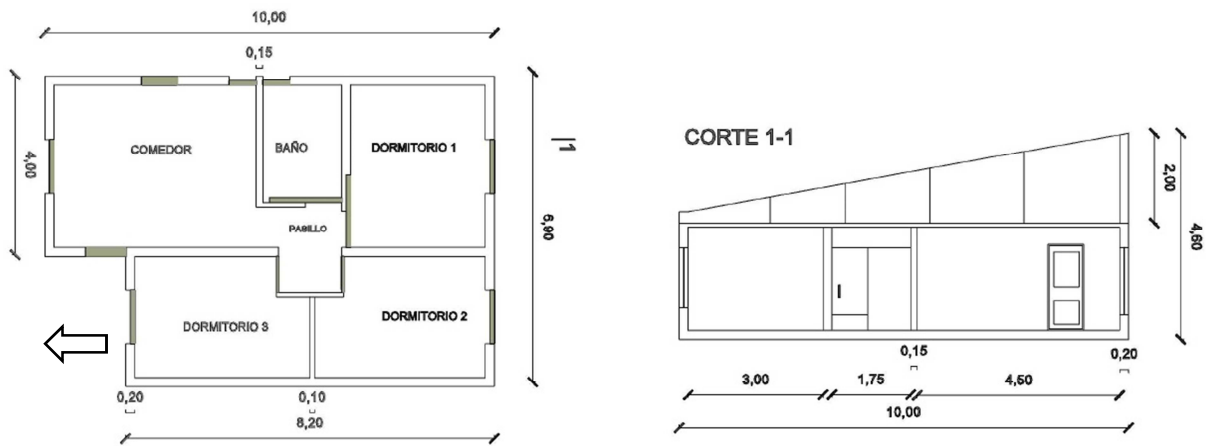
(Izq.) Vista en planta de la vivienda analizada. (Der.) Vista en corte de la vivienda.
